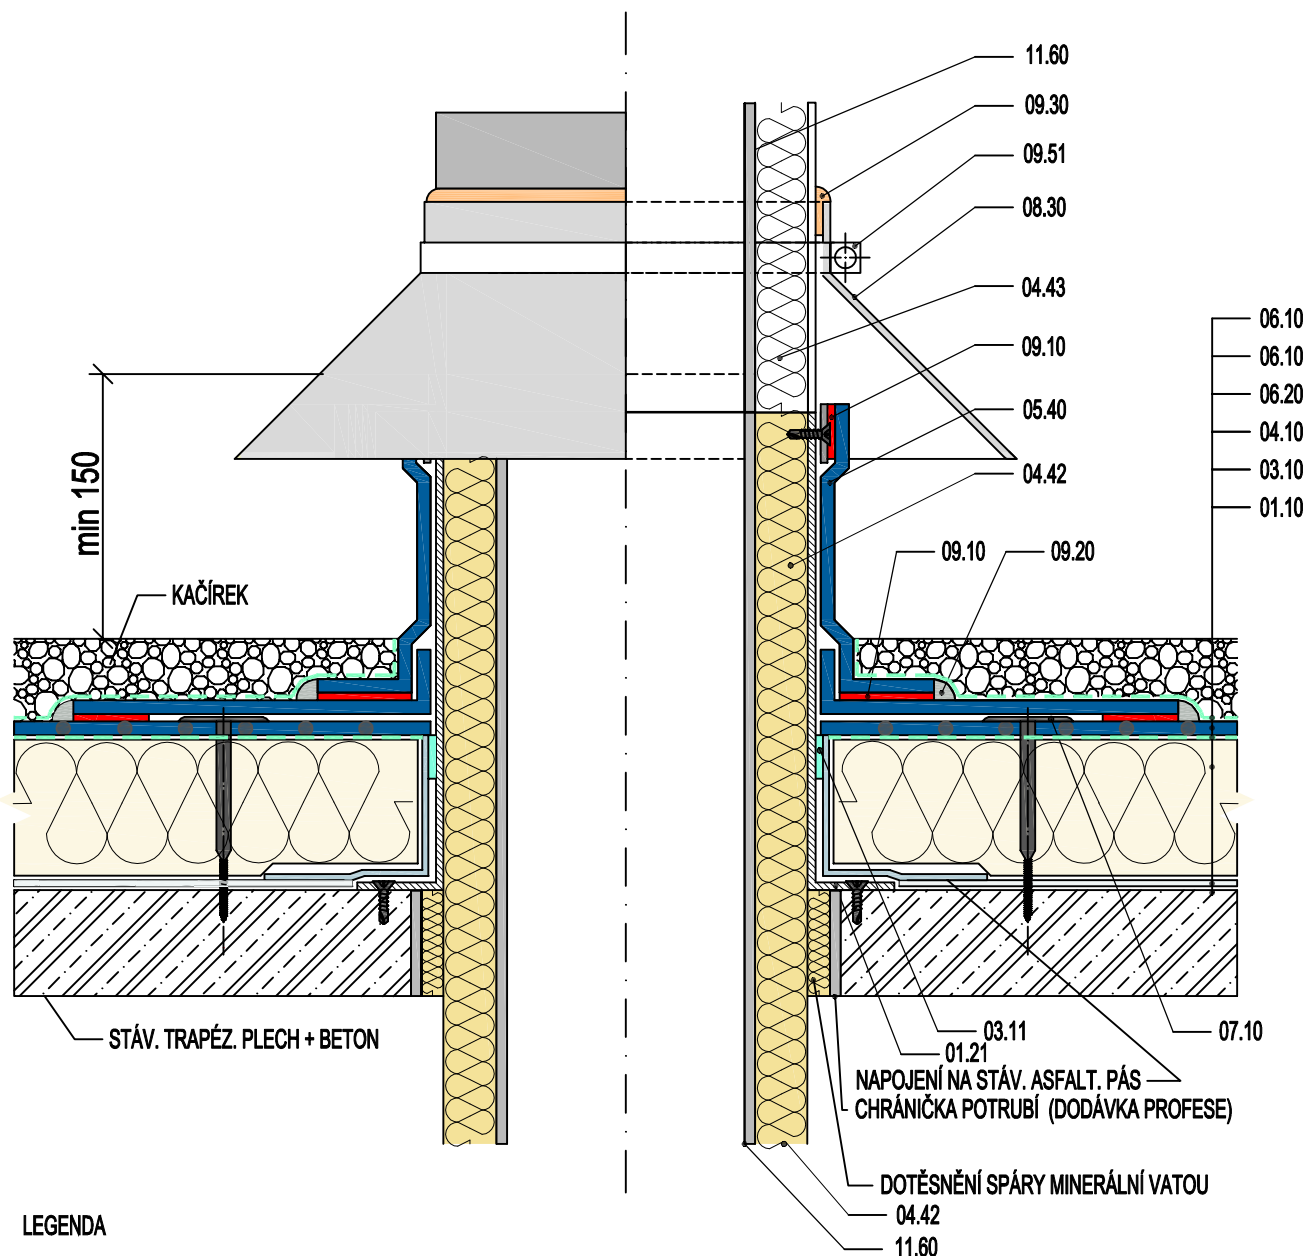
## DETAIL PROSTUPU VZT POTRUBÍ STŘECHOU
